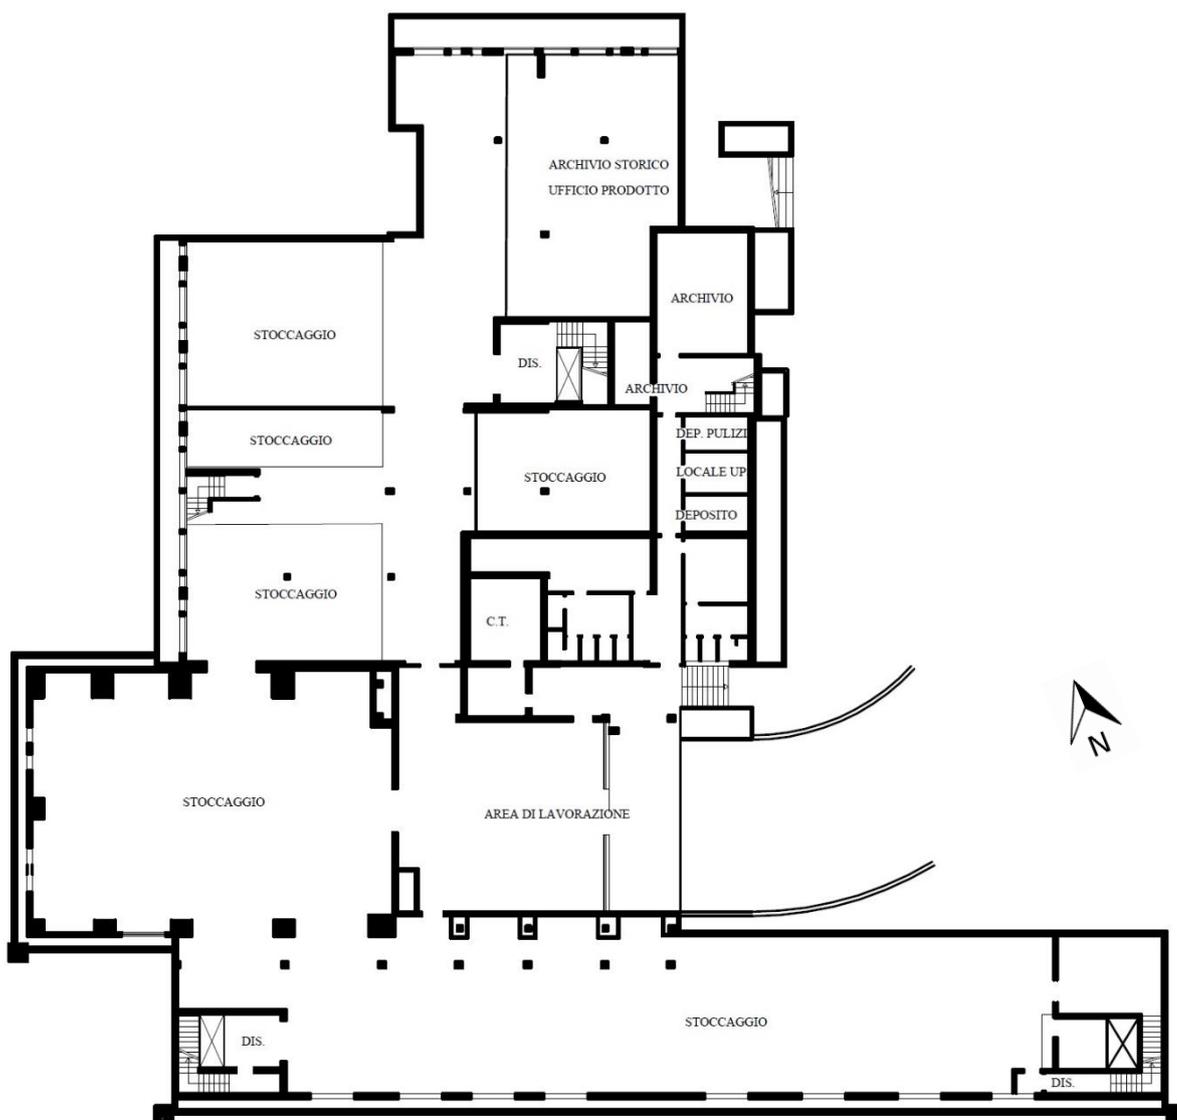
Pianta primo terra, scala 1:500. Fonte: Bottega Veneta.
